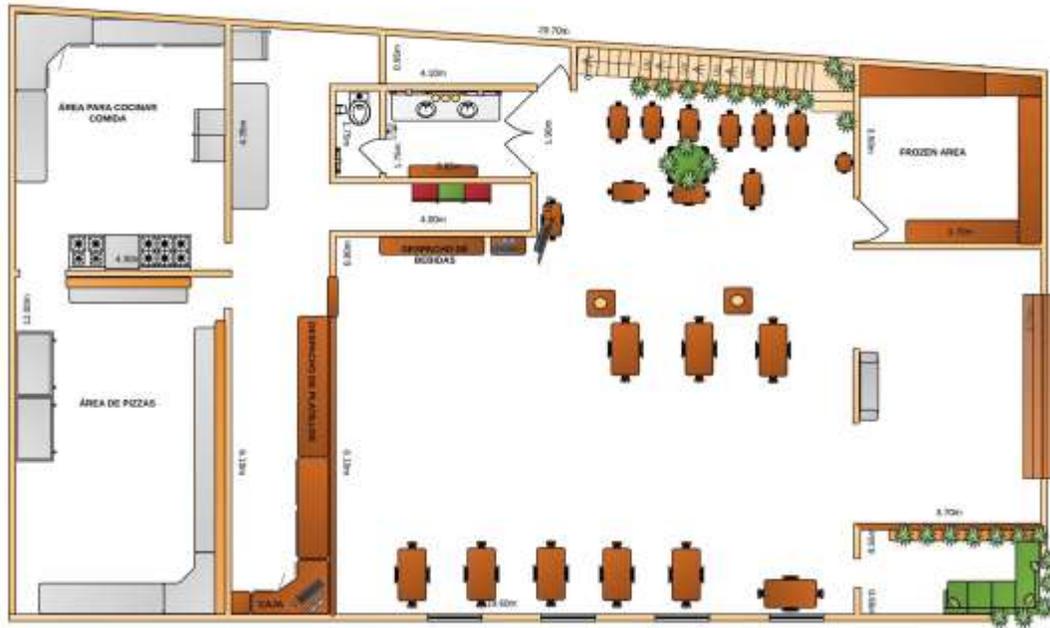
Distribución en planta propuesta para el Restaurante Simmer Down, primera planta.
